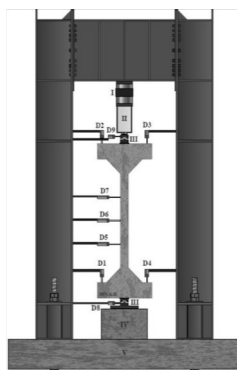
Pilar posicionado no pórtico de reação com a instrumentação
